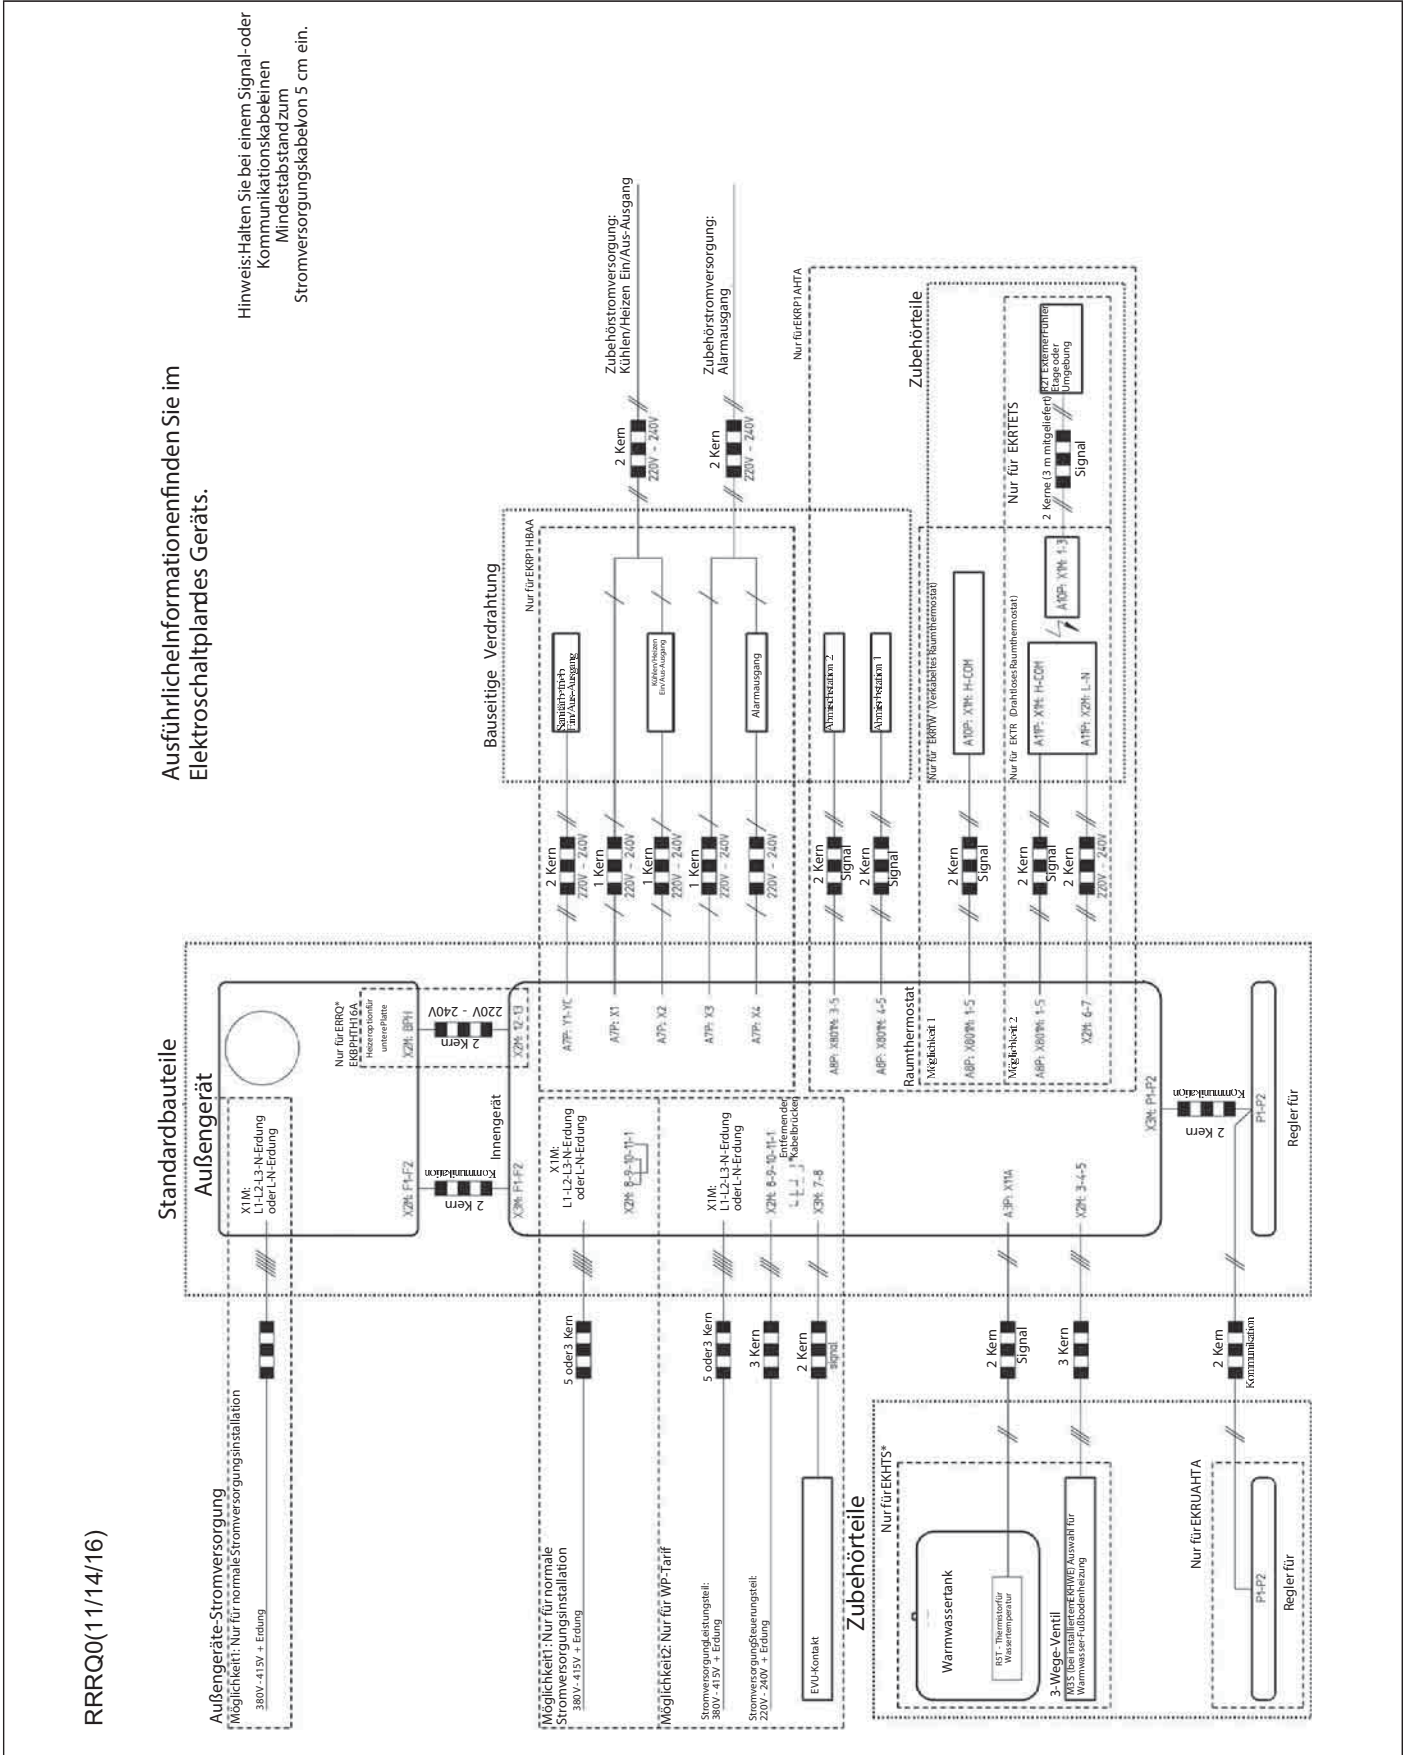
Anschlussplan - HPSU hitemp 11/14/16 kW
